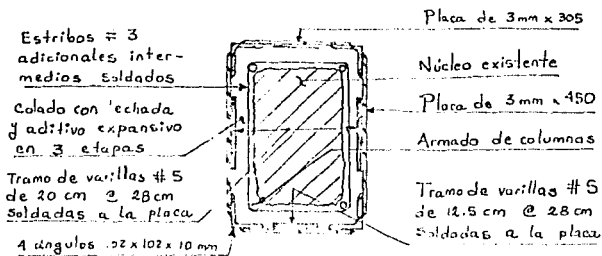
SECCIÓN TÍPICA DEL REFUERRO DE COLUMNAS
